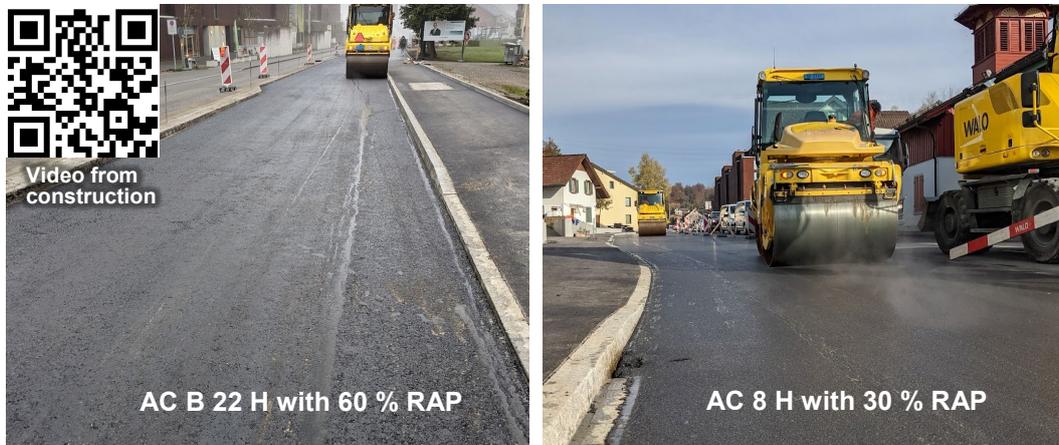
Construction d'une section d'essai HighRAP à Uster
